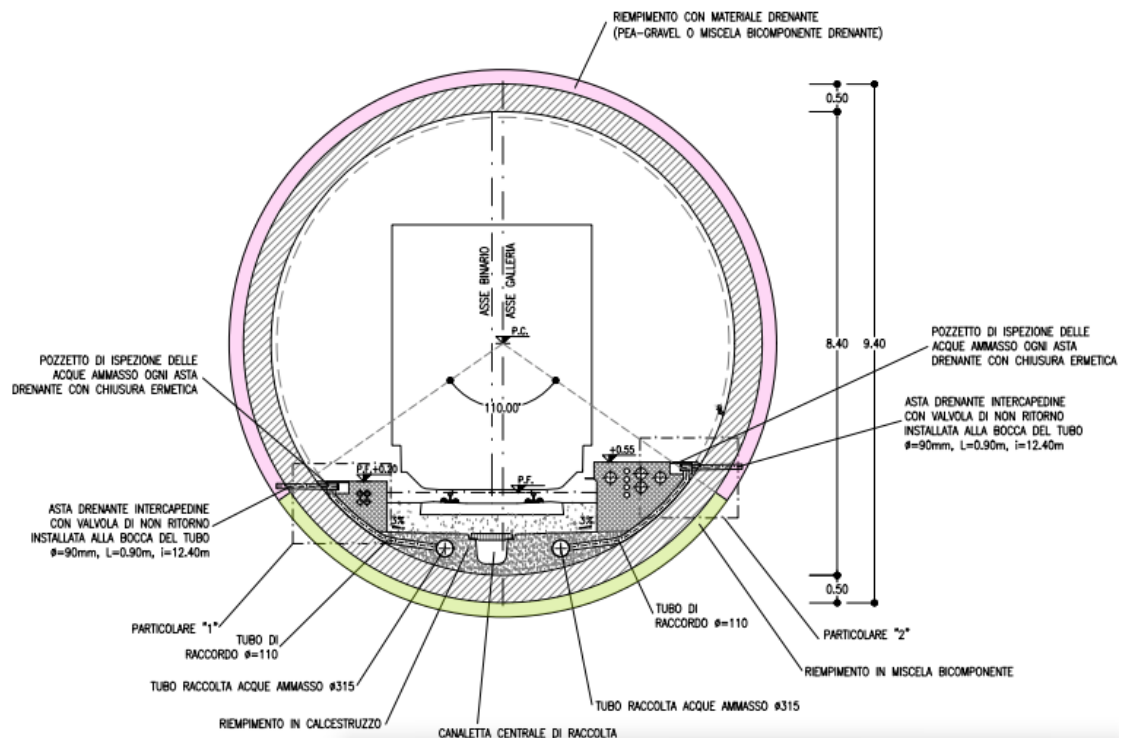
Sistema di drenaggio acque d'ammasso - DR1
